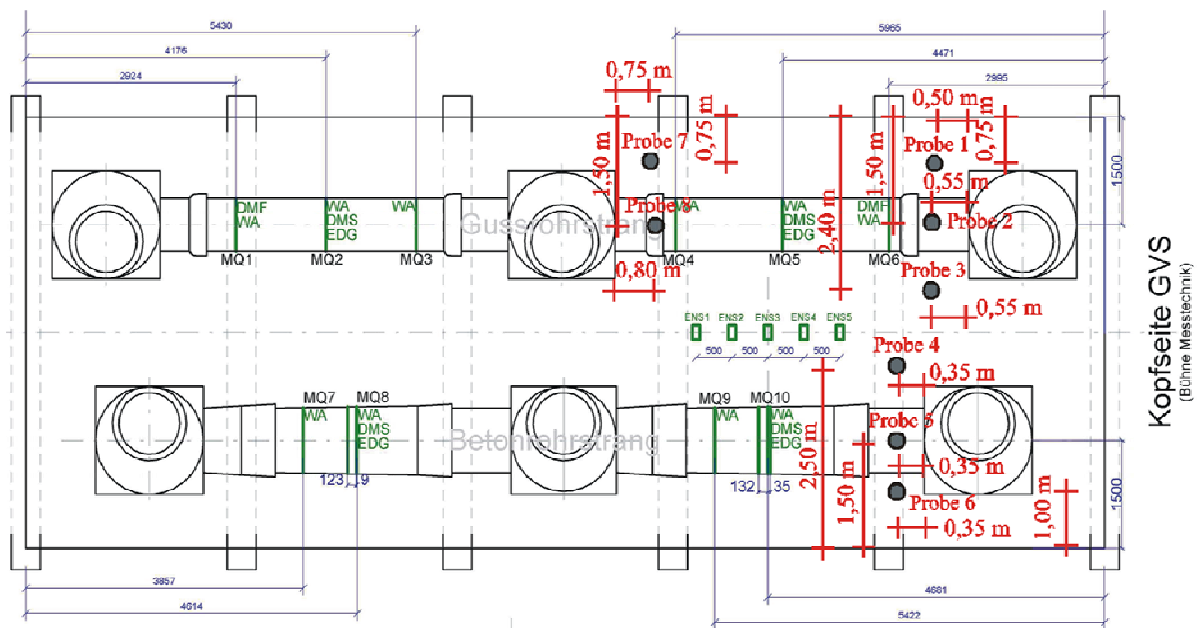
Draufsicht Großversuchsstand mit Lage der Entnahmestellen der Proben
